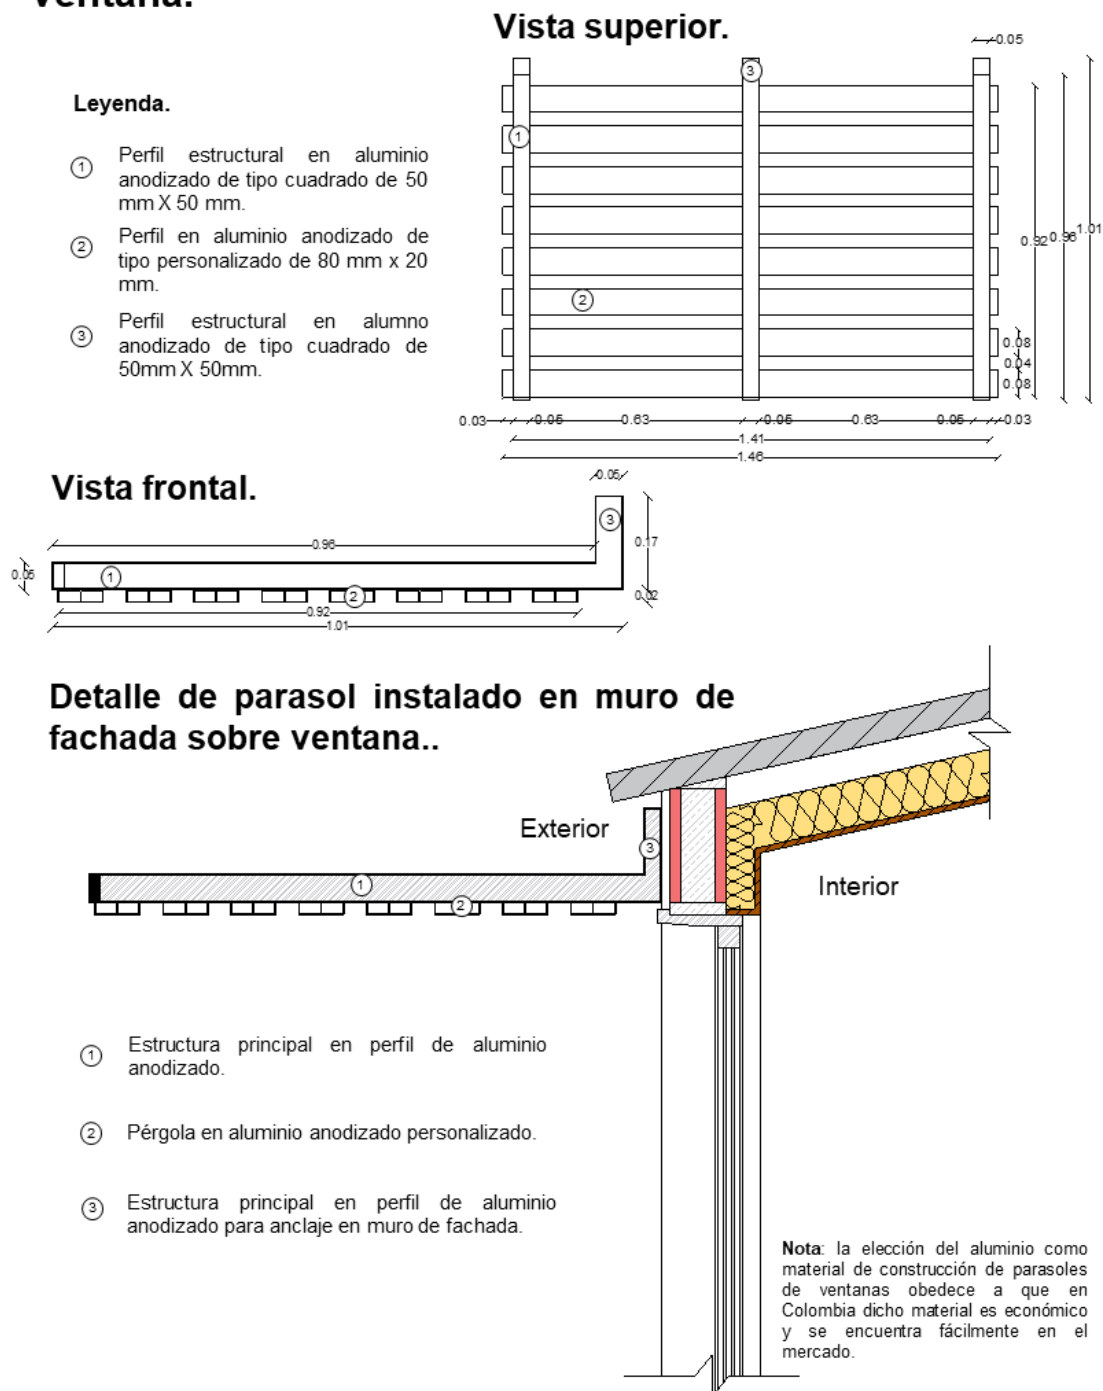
Detalle de solución constructiva de parasol fijo sobre ventana. Fuente: elaboración propia.
